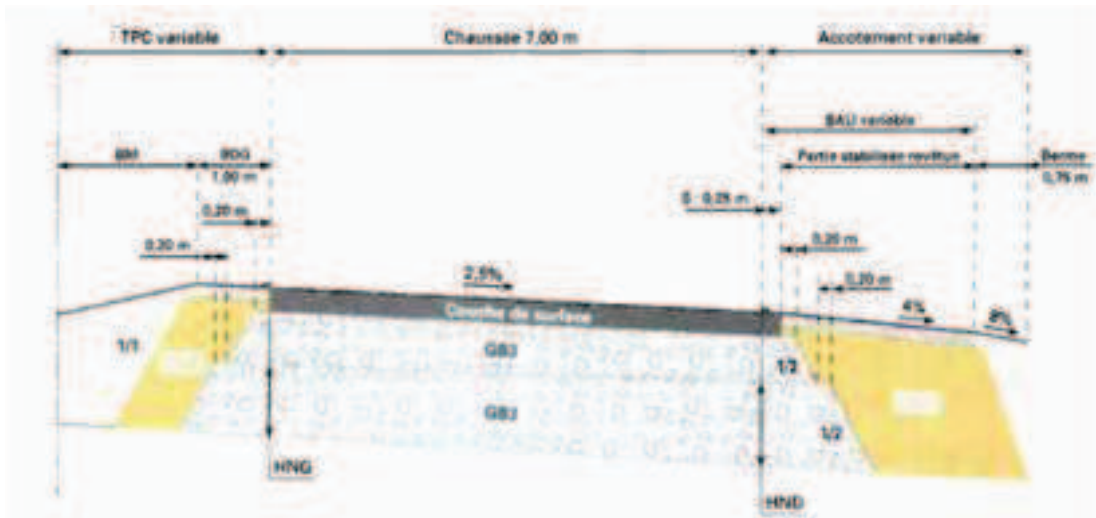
Secció transversal tipus d'una Structure bitumineuse épaisse GB3/GB3. Catalogue de structures de chaussées [SETRA].
